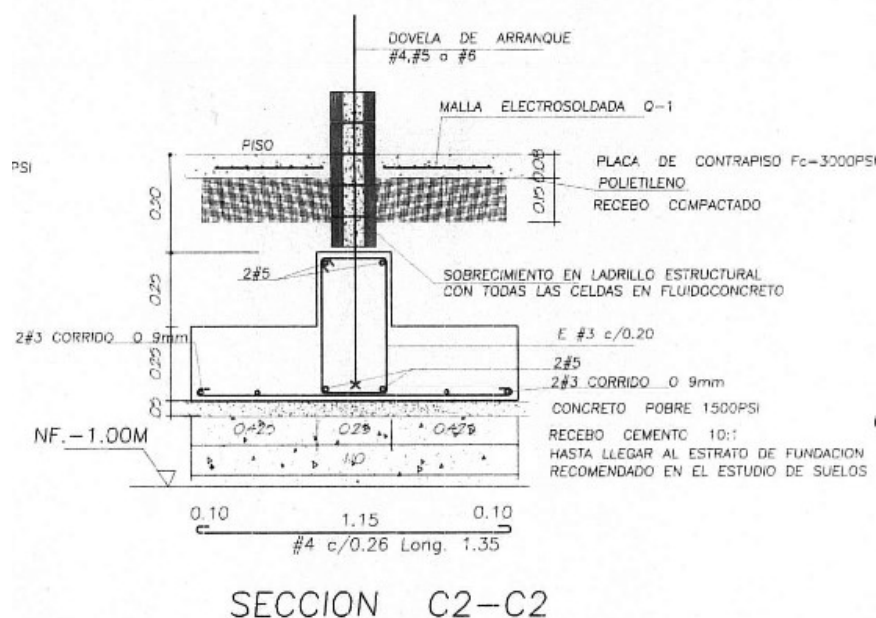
Detalle refuerzo cimentación viga T invertida. (Fuente Plano estructural 01)
